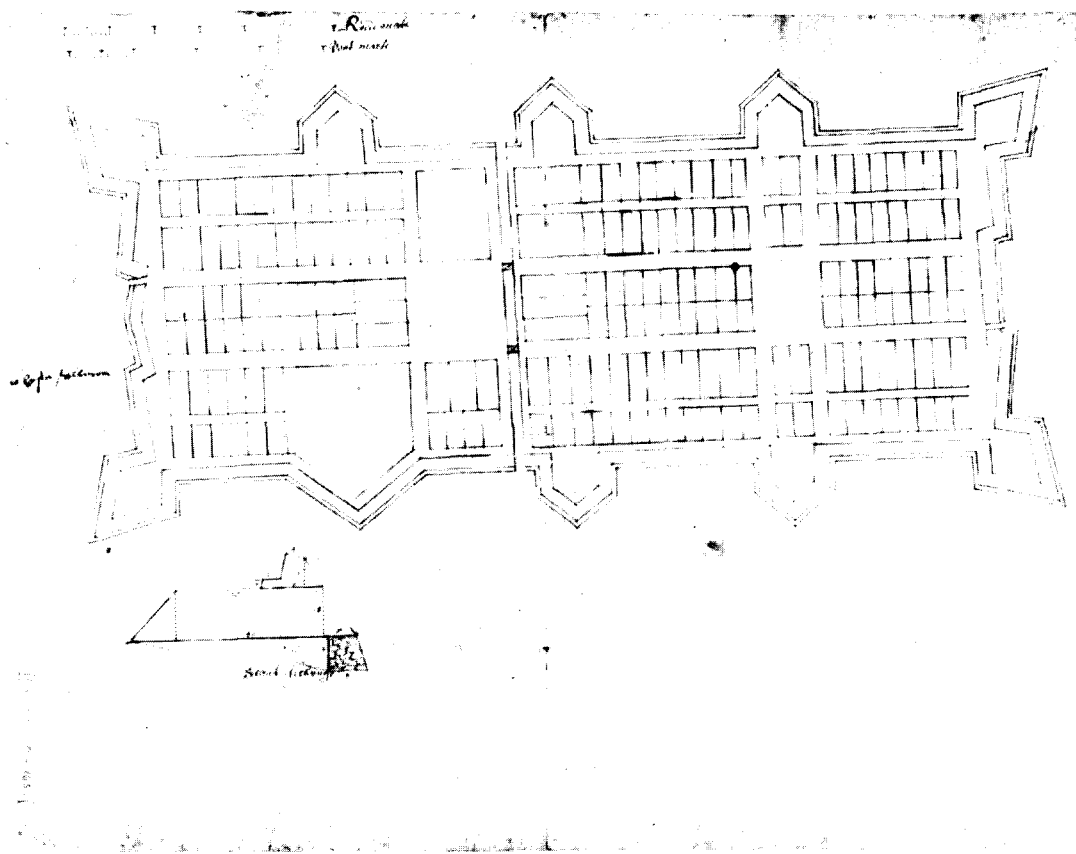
Simon Stevin, grondplan „Cittadella murata”, uit: Vande Oirdeningh der Steden (ca. 1600), kopergravure.
